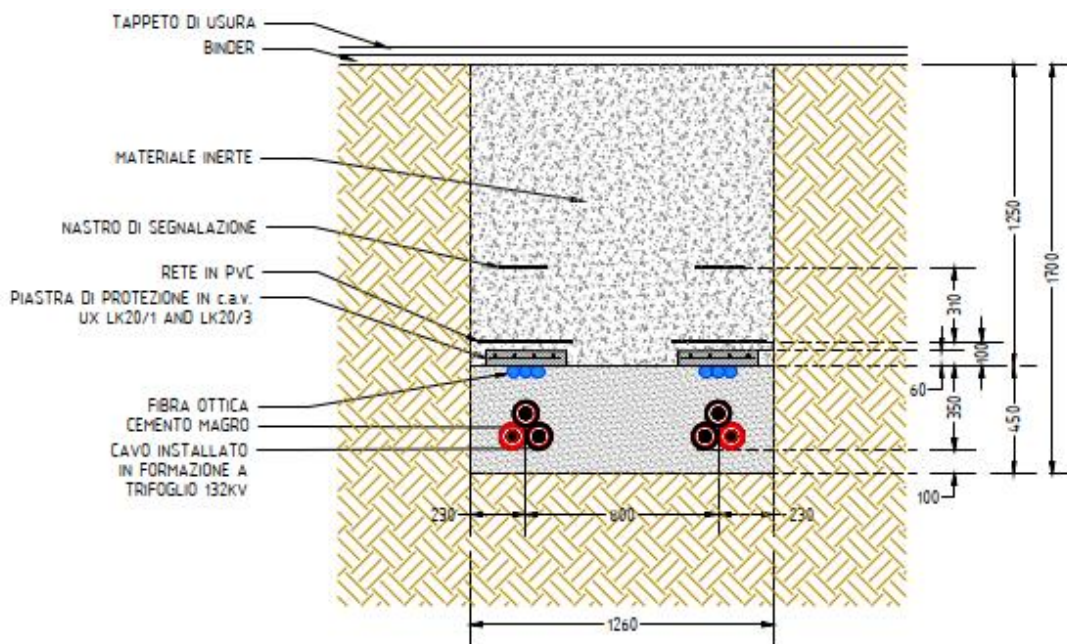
Sezione tipo stradale – Tratto di cavidotto dal punto di giunzione alla stazione di trasformazione.
